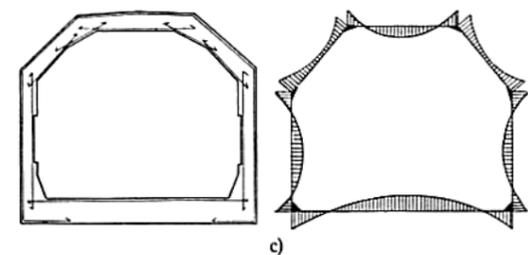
Tunnelrahmen aus bewehrtem Beton.
